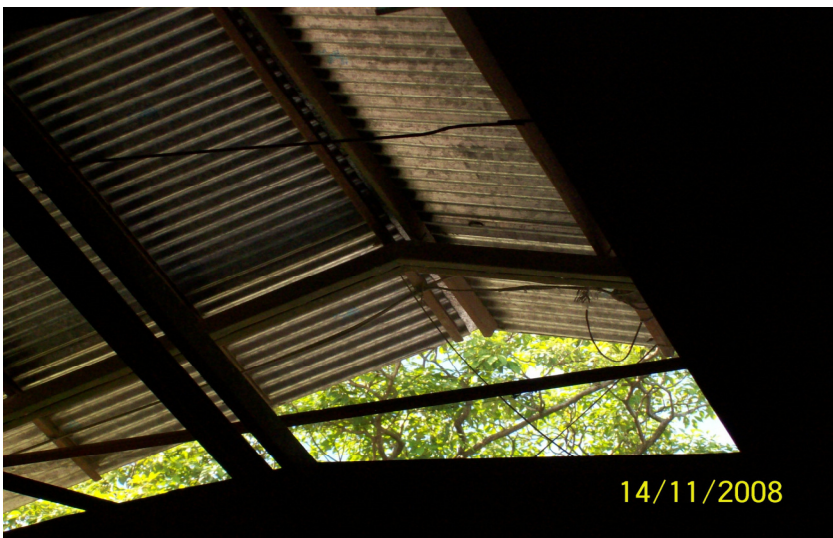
Planta posee cumbreras las cuales se encuentran provistas con cedazo.
